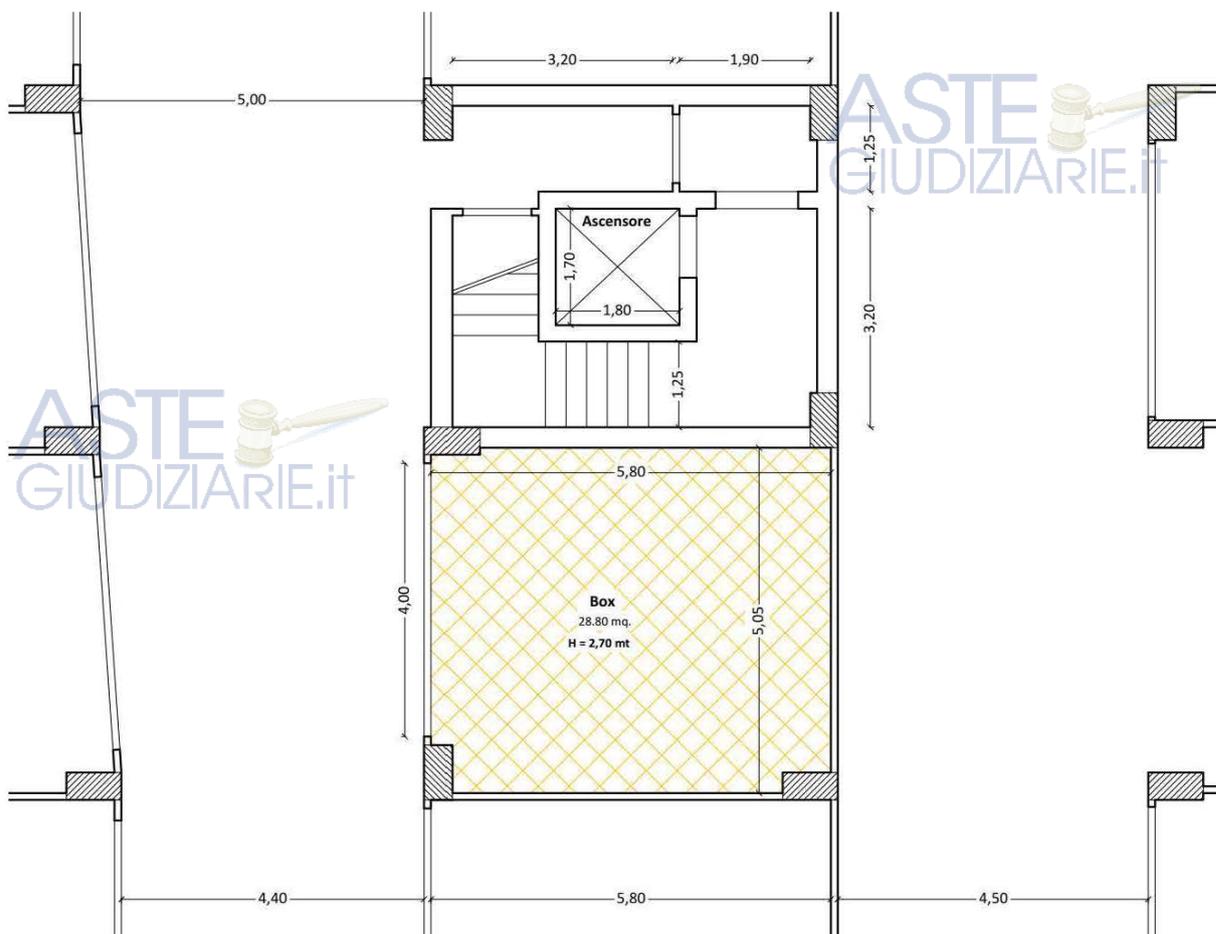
Planimetria dell'unità immobiliare oggetto di stima - Sub 50 – Secondo livello sottostrada
